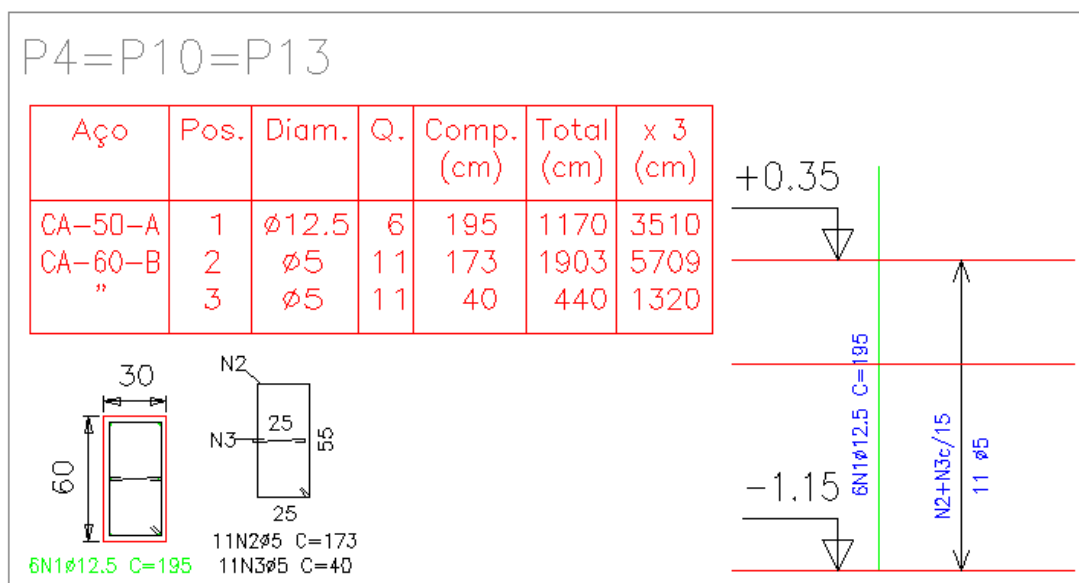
Detalhamento do pilar P13 ao nível da fundação.
